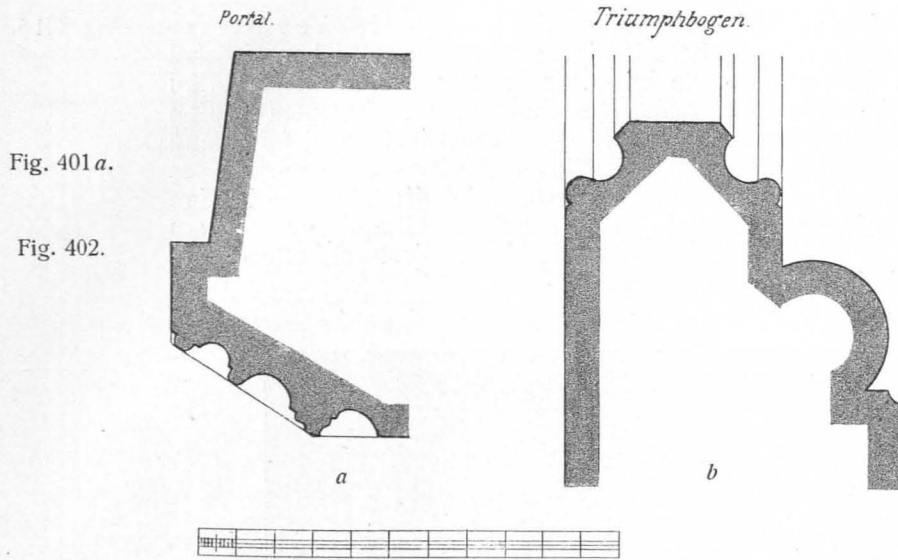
Dorfbeuern, Pfarrkirche, Details, 1:20
